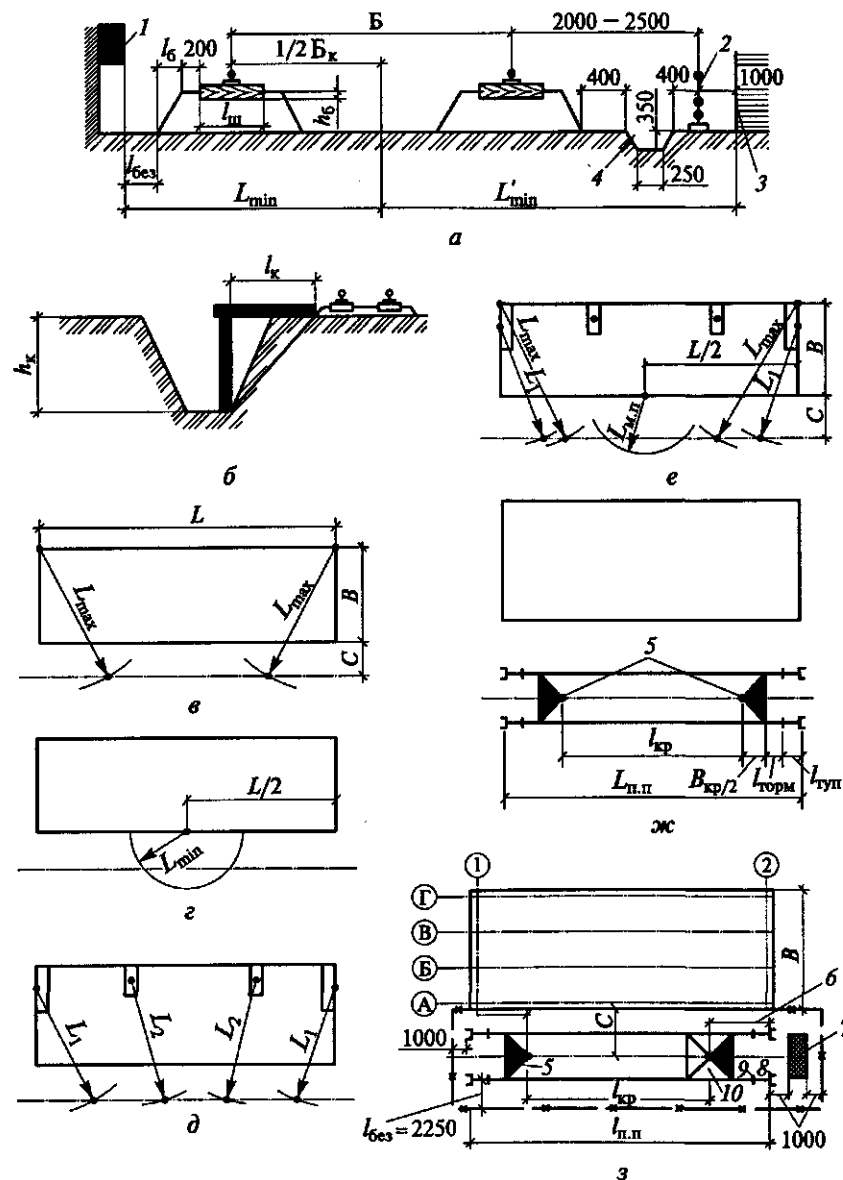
Схемы поперечной и продольной привязок крановых путей:
